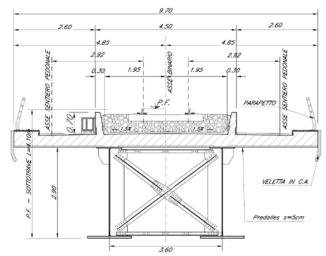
Sezione trasversale campate in acciaio-cls L=40 m
